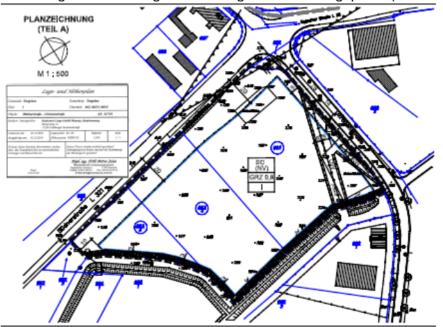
Darstellung 3. Änderung des Bebauungsplans (ohne Maßstab)
